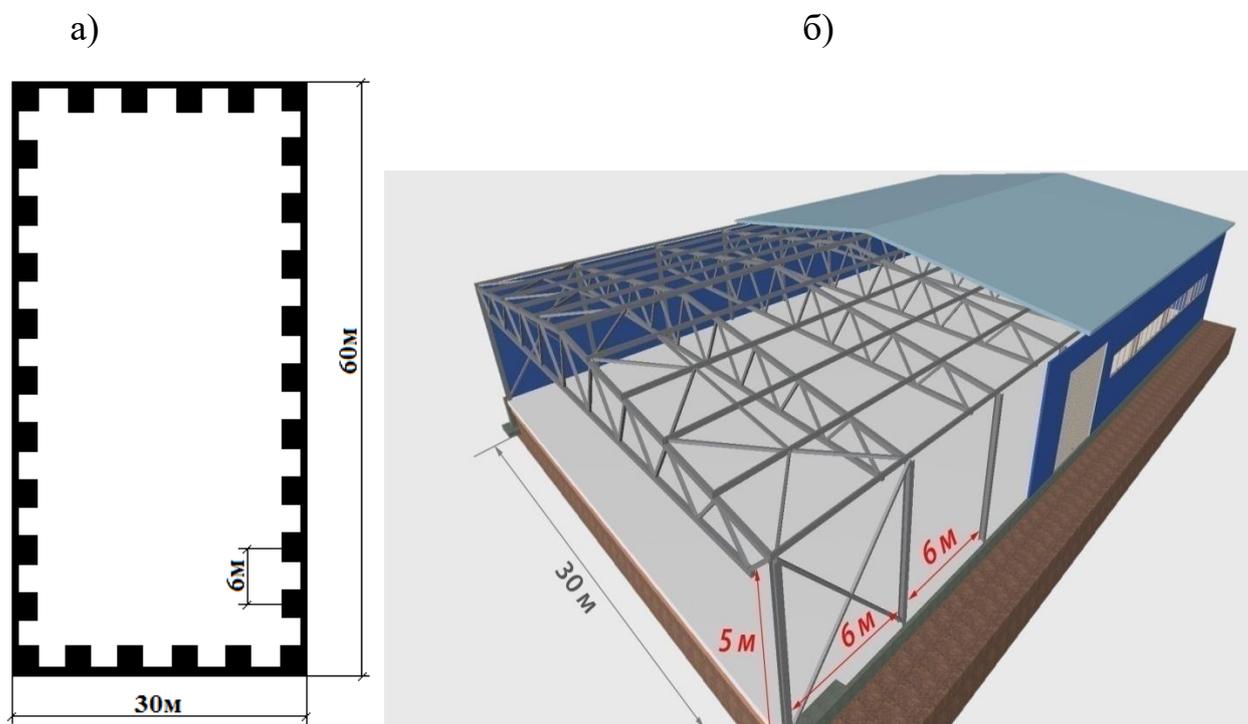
а) Схема расположения опор фундамента; б) Типовая конструкторская модель металлоконструкции здания с пролетом 30м
